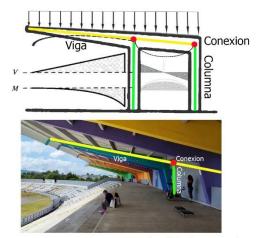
Análisis Estructural Erick Bernabé Barrondo. Fuente: Elaboración Propia
